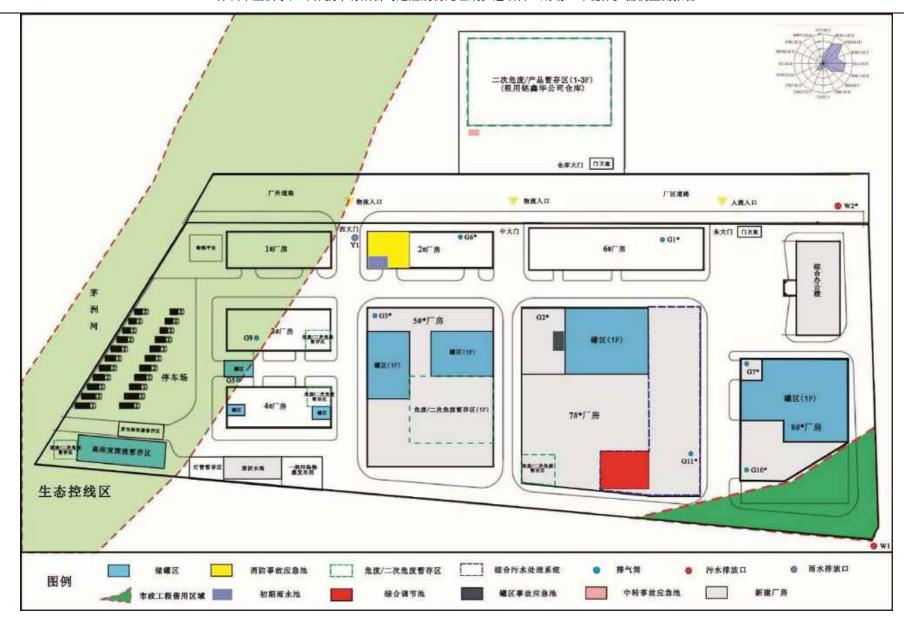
改扩建全部完成后厂区平面布置图(拟新建构筑物一期未新建)
